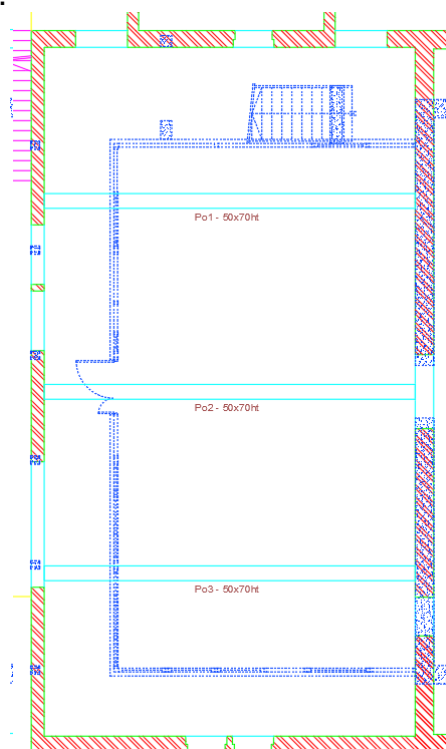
& 33 : Poutre béton 50x70ht du plancher de l'aile Ouest & plan de repérage des poutres béton
